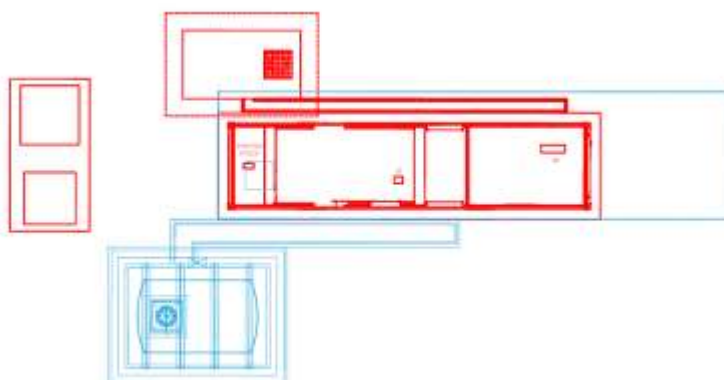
Pianta gruppo elettrogeno nel Progetto approvato
